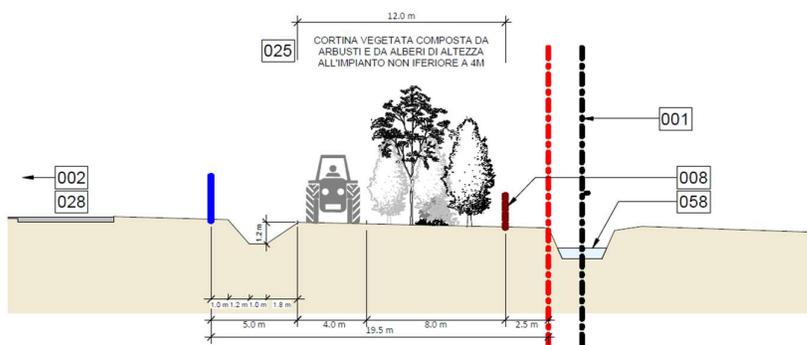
Sezione proposta paesaggistica del piano attuativo approvato
